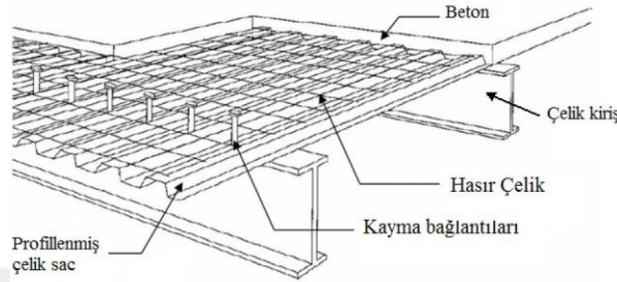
Çelik konstruksiyon taşıyıcı sisteme ait kat statik döşeme.
